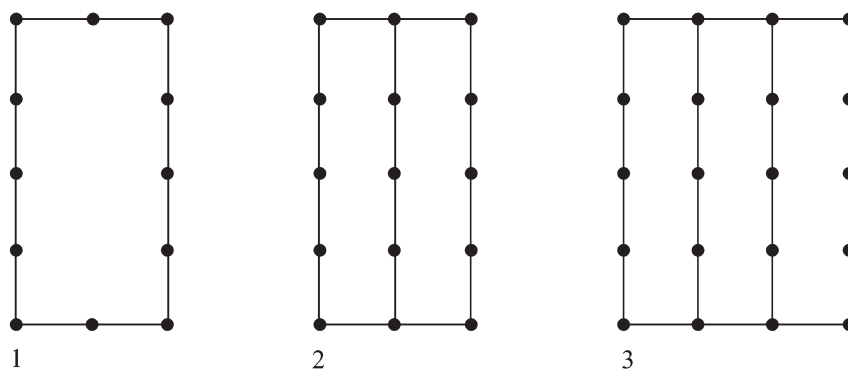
Schematische Aufsicht. 1: einschiffiger Grundriss, 2: zweischiffiger Grundriss, 3: dreischiffiger Grundriss.
